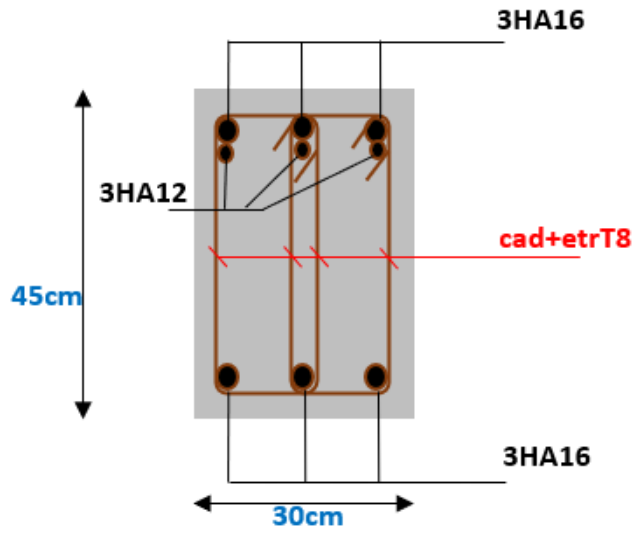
Ferrailage en appui -Poutre principale-
